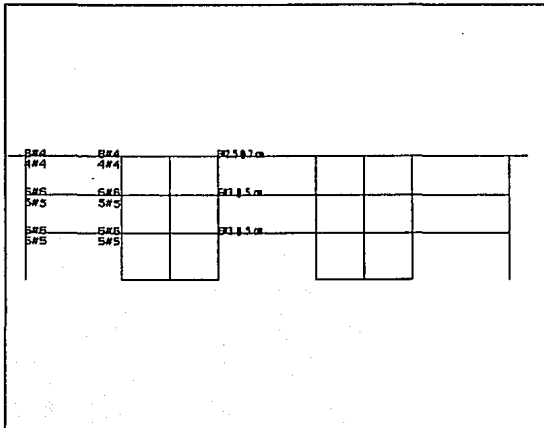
Armados de las vigas del eje A, modelo 2, Q=4
